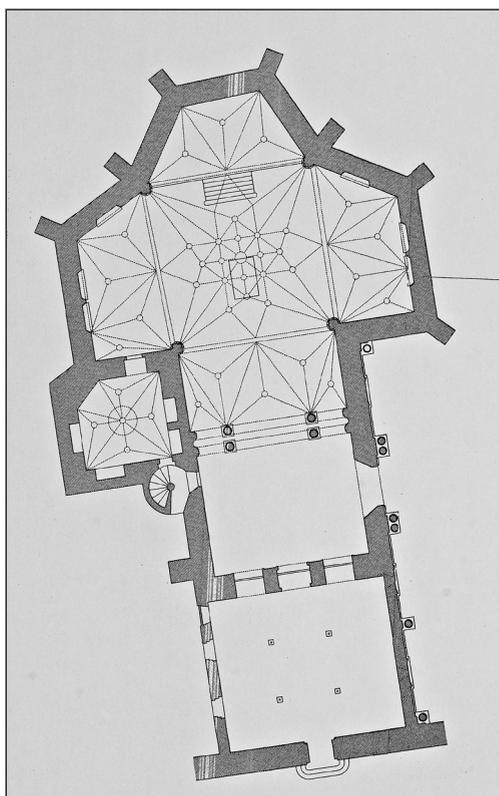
Planta de la capilla. I. Picazo. JCYL.
